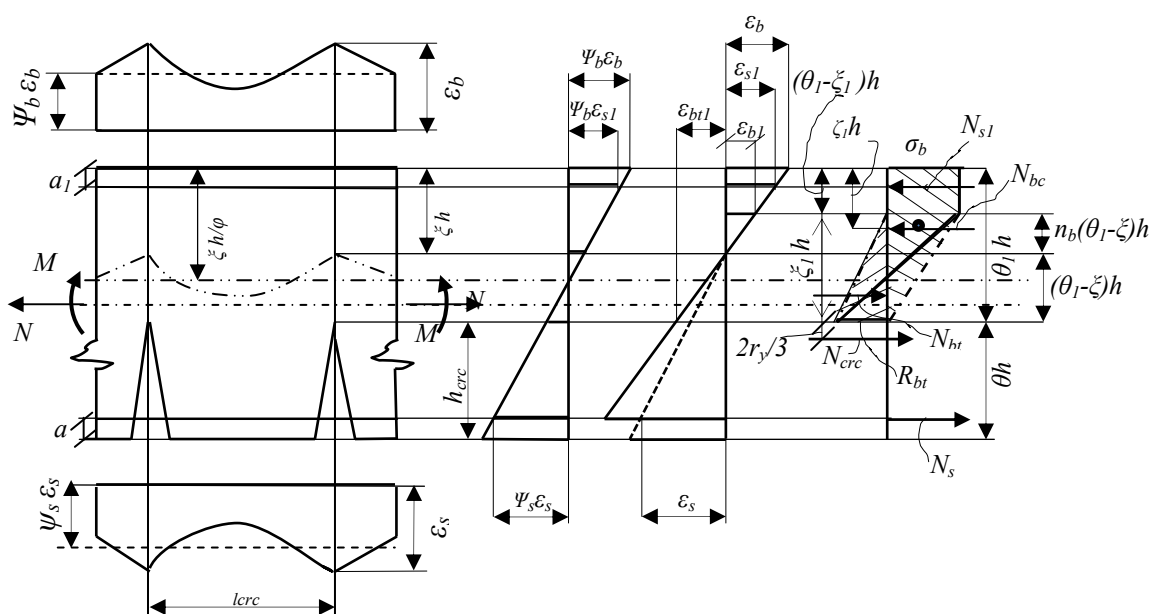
Расчётная схема железобетонного элемента с трещинами при нелинейном деформировании бетона сжатой зоны
